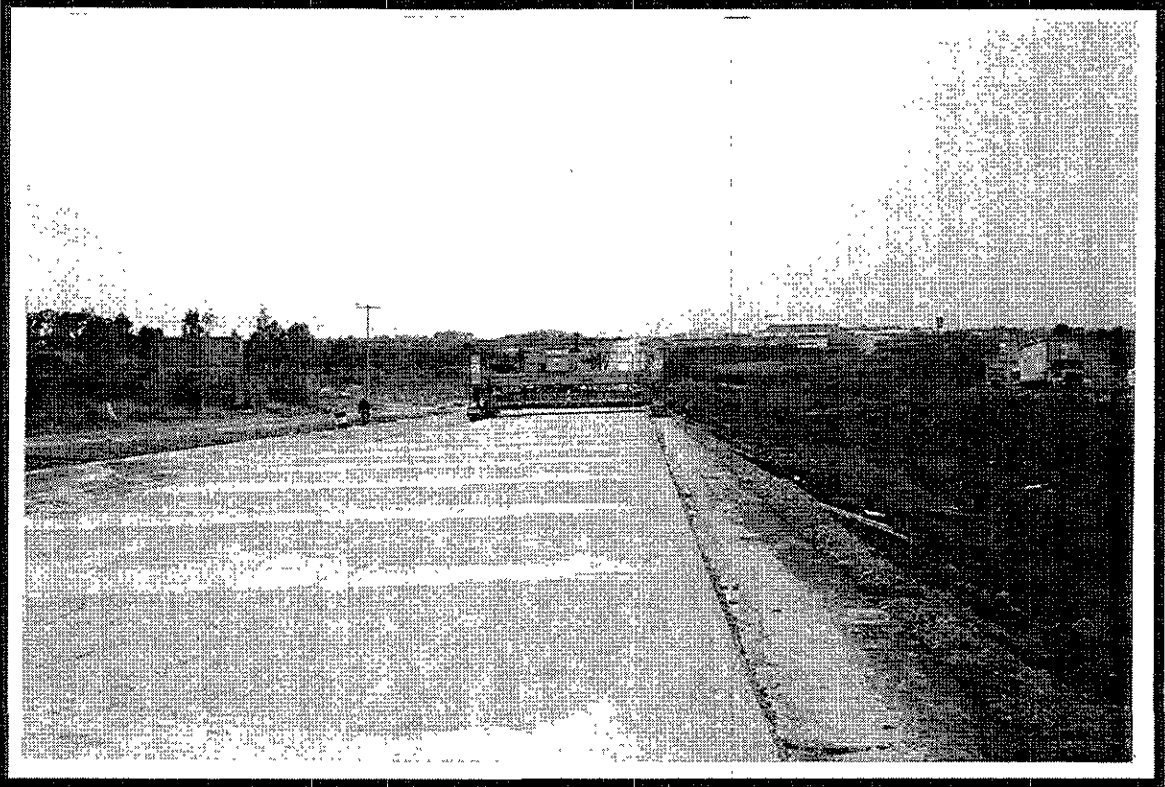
Pavimentadora de concreto hidráulico autopropulsada, con cimbra deslizante integrada y para anchos hasta de 12 metros.
